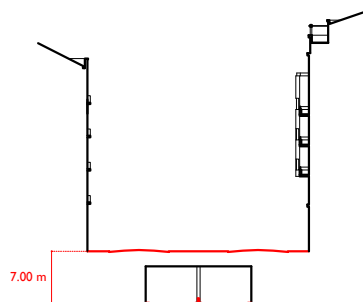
• Secção transversal da rua com múltiplos planos horizontais. Secções transversais (1:1.000).
